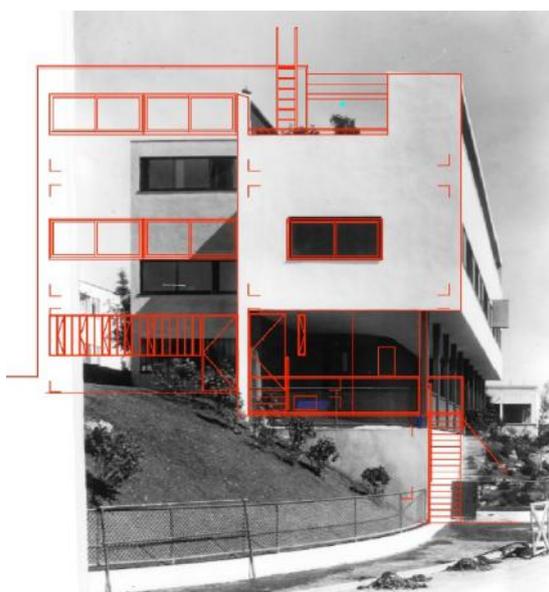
Comparación del estado previo de la fachada sur con su restauración prevista.
